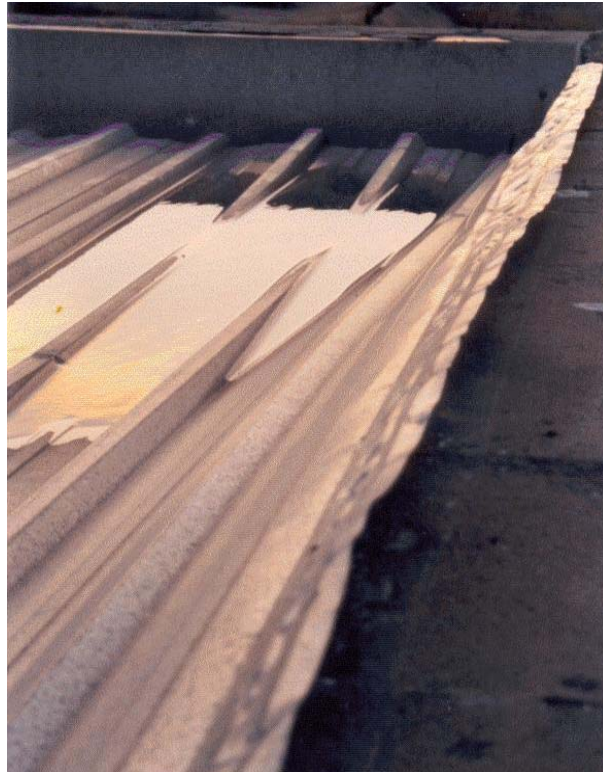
Telhas metálicas da cobertura de uma subestação de energia elétrica amassadas, com endossamento de água, causando infiltrações dentro da subestação.
